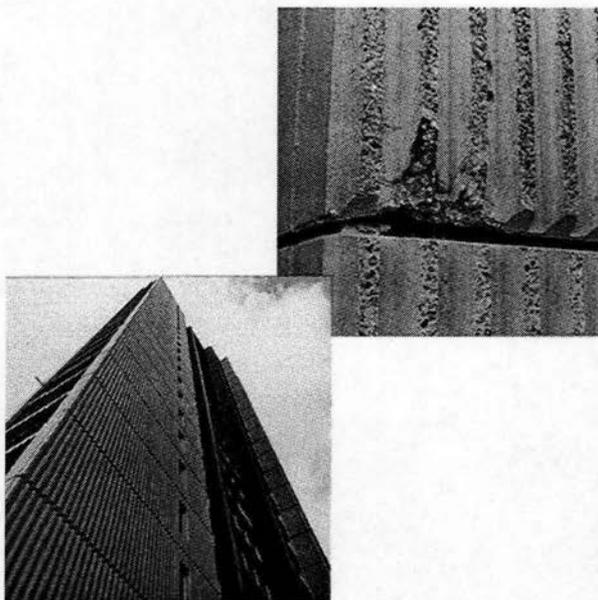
Edificio de apartamentos de 24 pisos con estructura en concreto y elementos arquitectónicos de fachada prefabricados.
